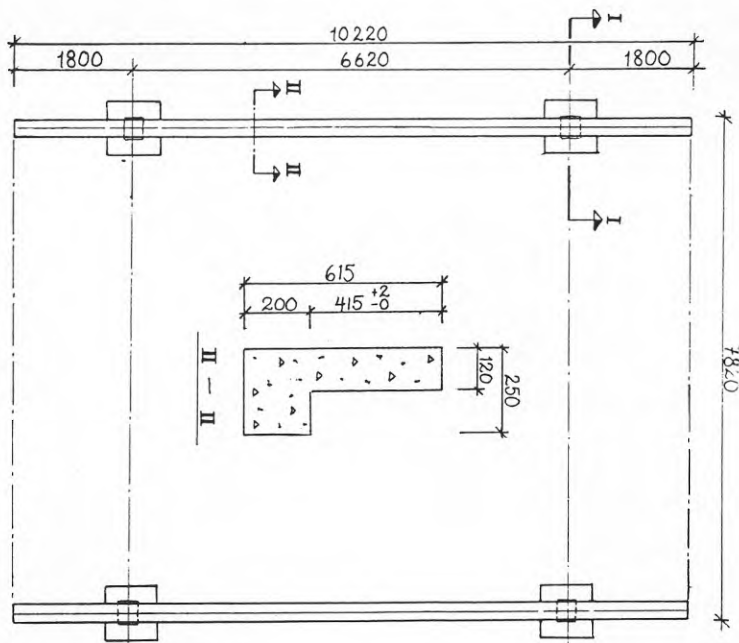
Grundplan med infälld sektion av grundbalk.
